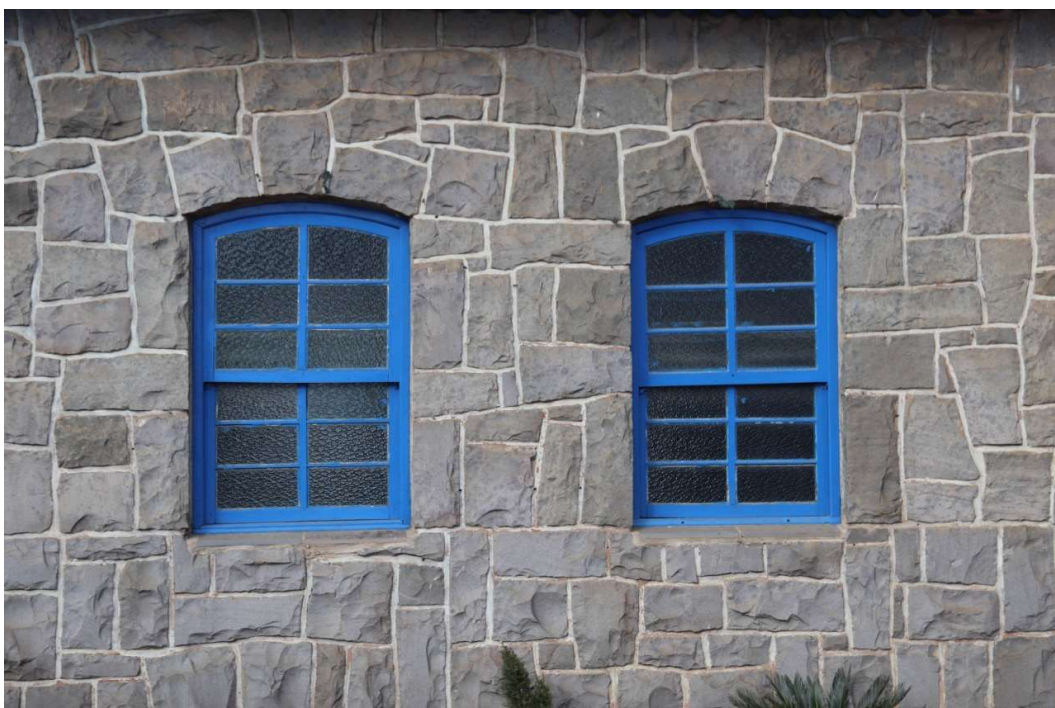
Imóvel IV- Prédio da Casa de Pedra – Detalhamento das esquadrias
